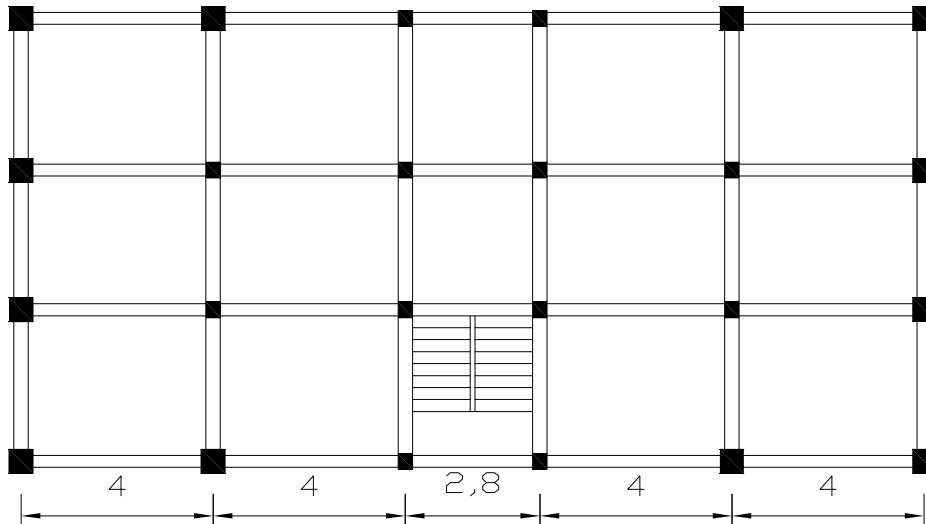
Vue en plan de la structure renforcée par gainage.
